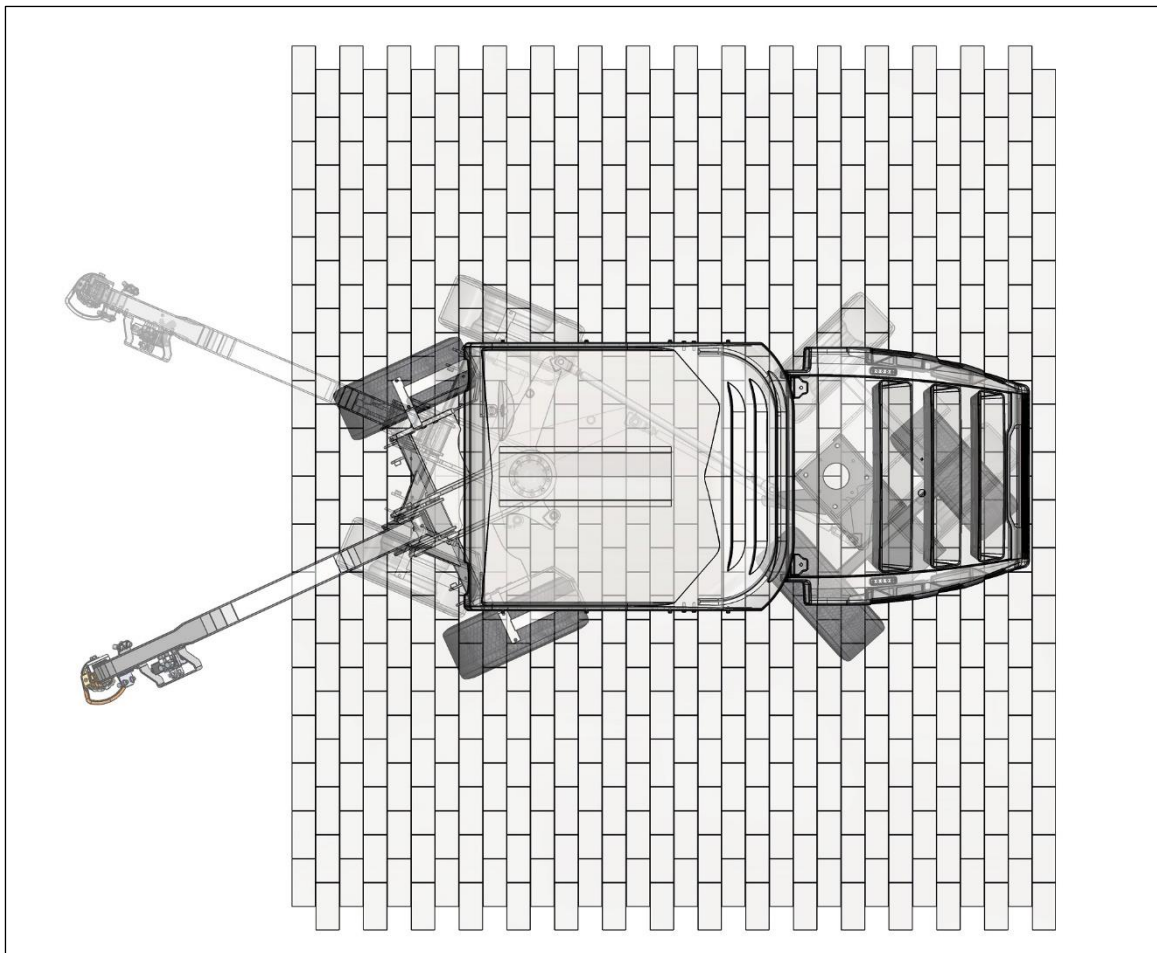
Prinzipskizze einer Verlegemaschine mit doppelter Knicklenkung [Quelle: Probst]
